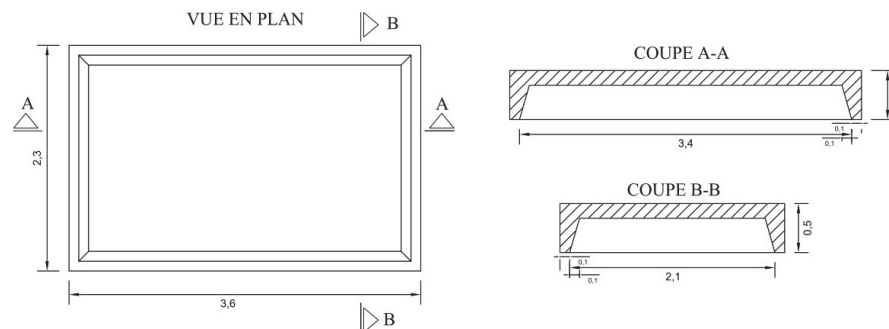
Vue en plan, coupes transversales et longitudinales de la prédalle de l'appontement
